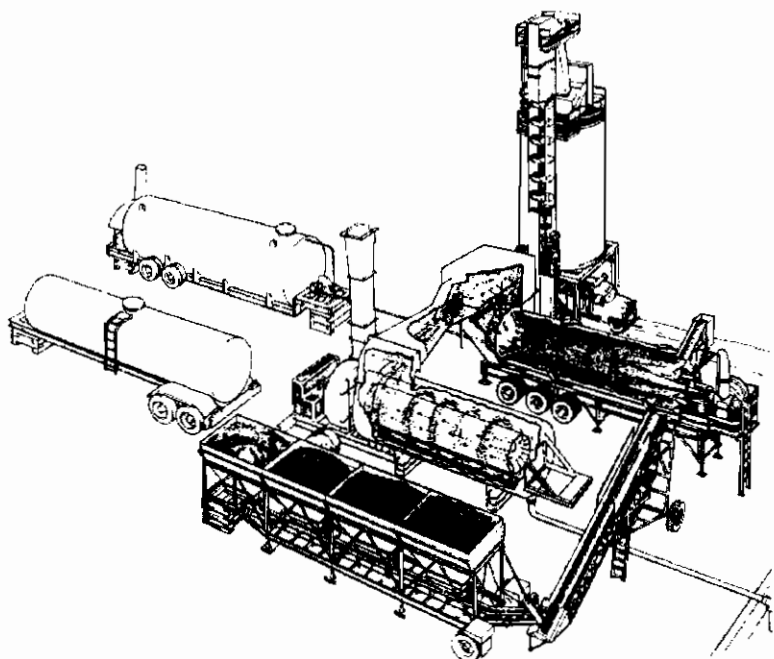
Esquema de Instalação de Mistura de Tambor
